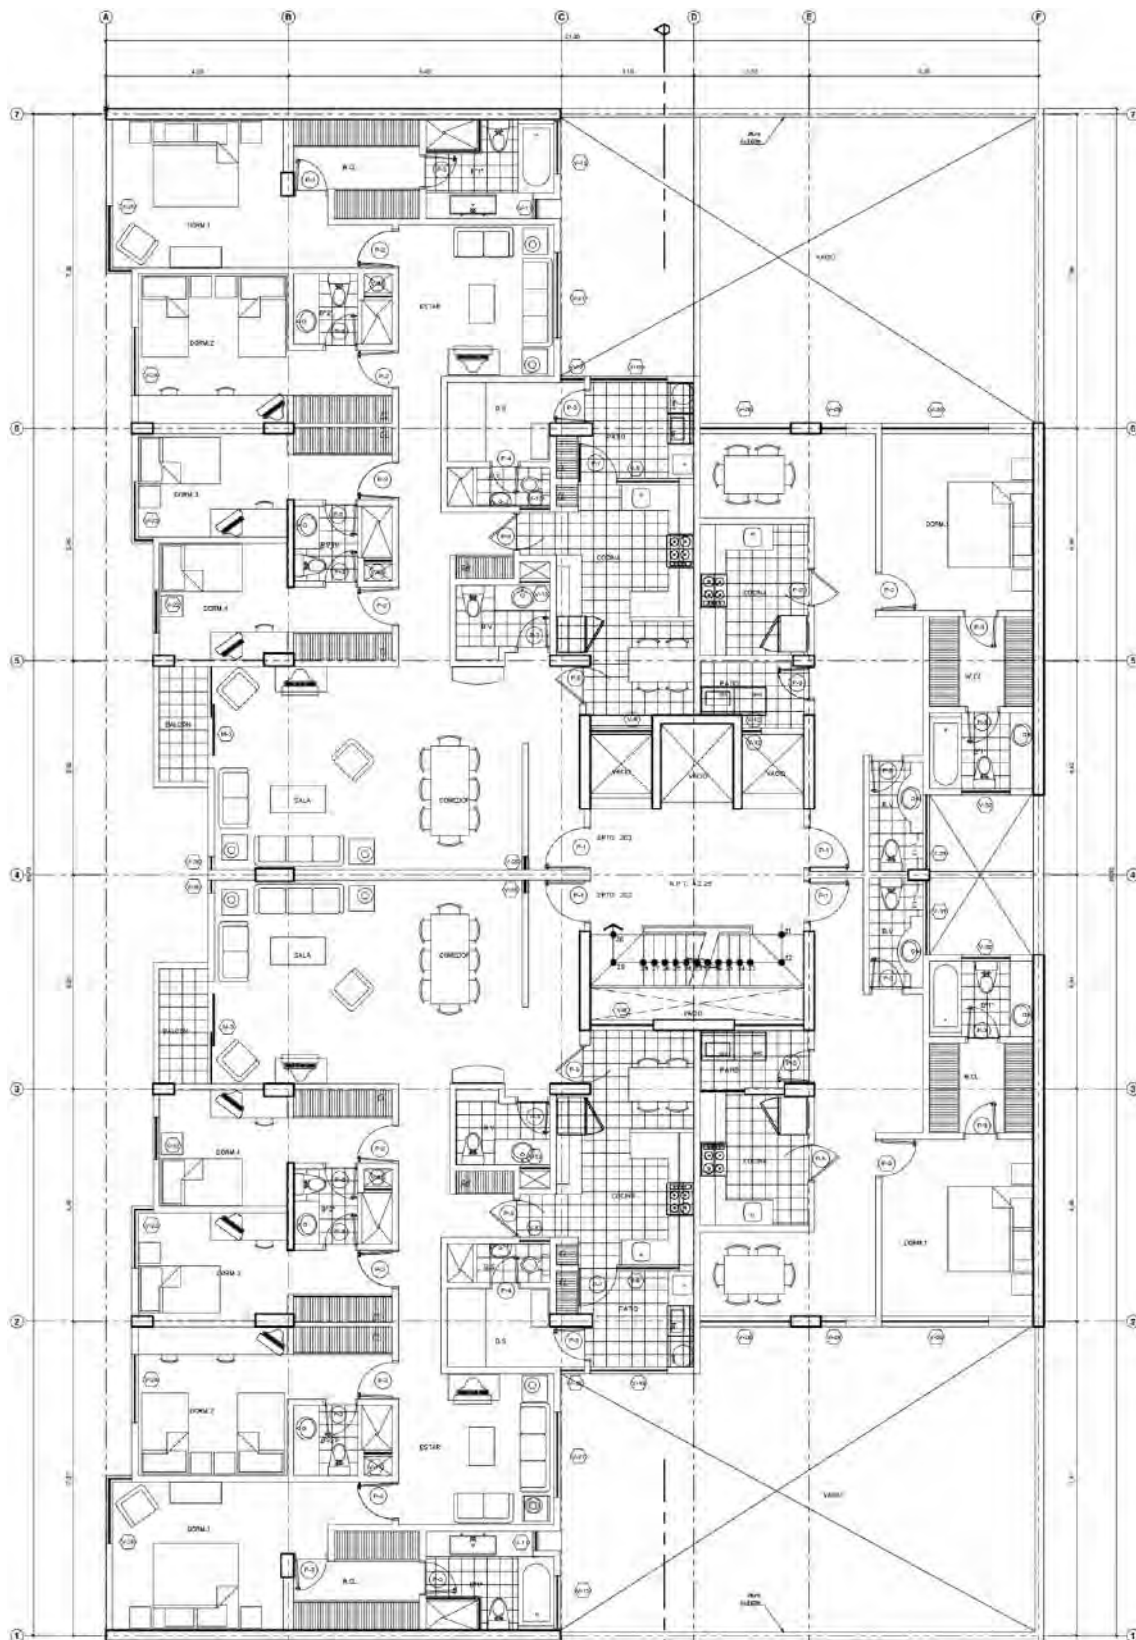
Plano de arquitectura piso típico (2° al 7° piso).
